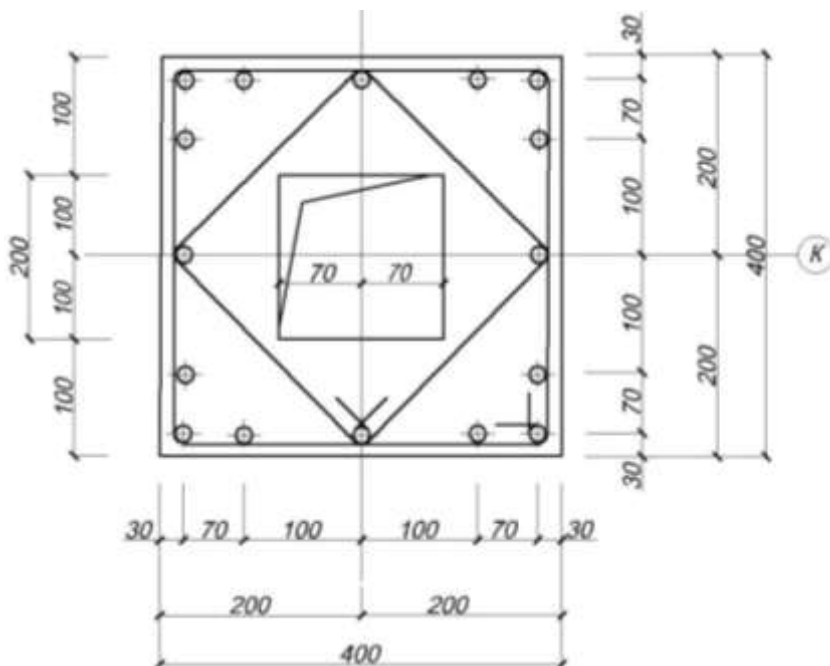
Схема армирования колонны 400 × 400 мм
